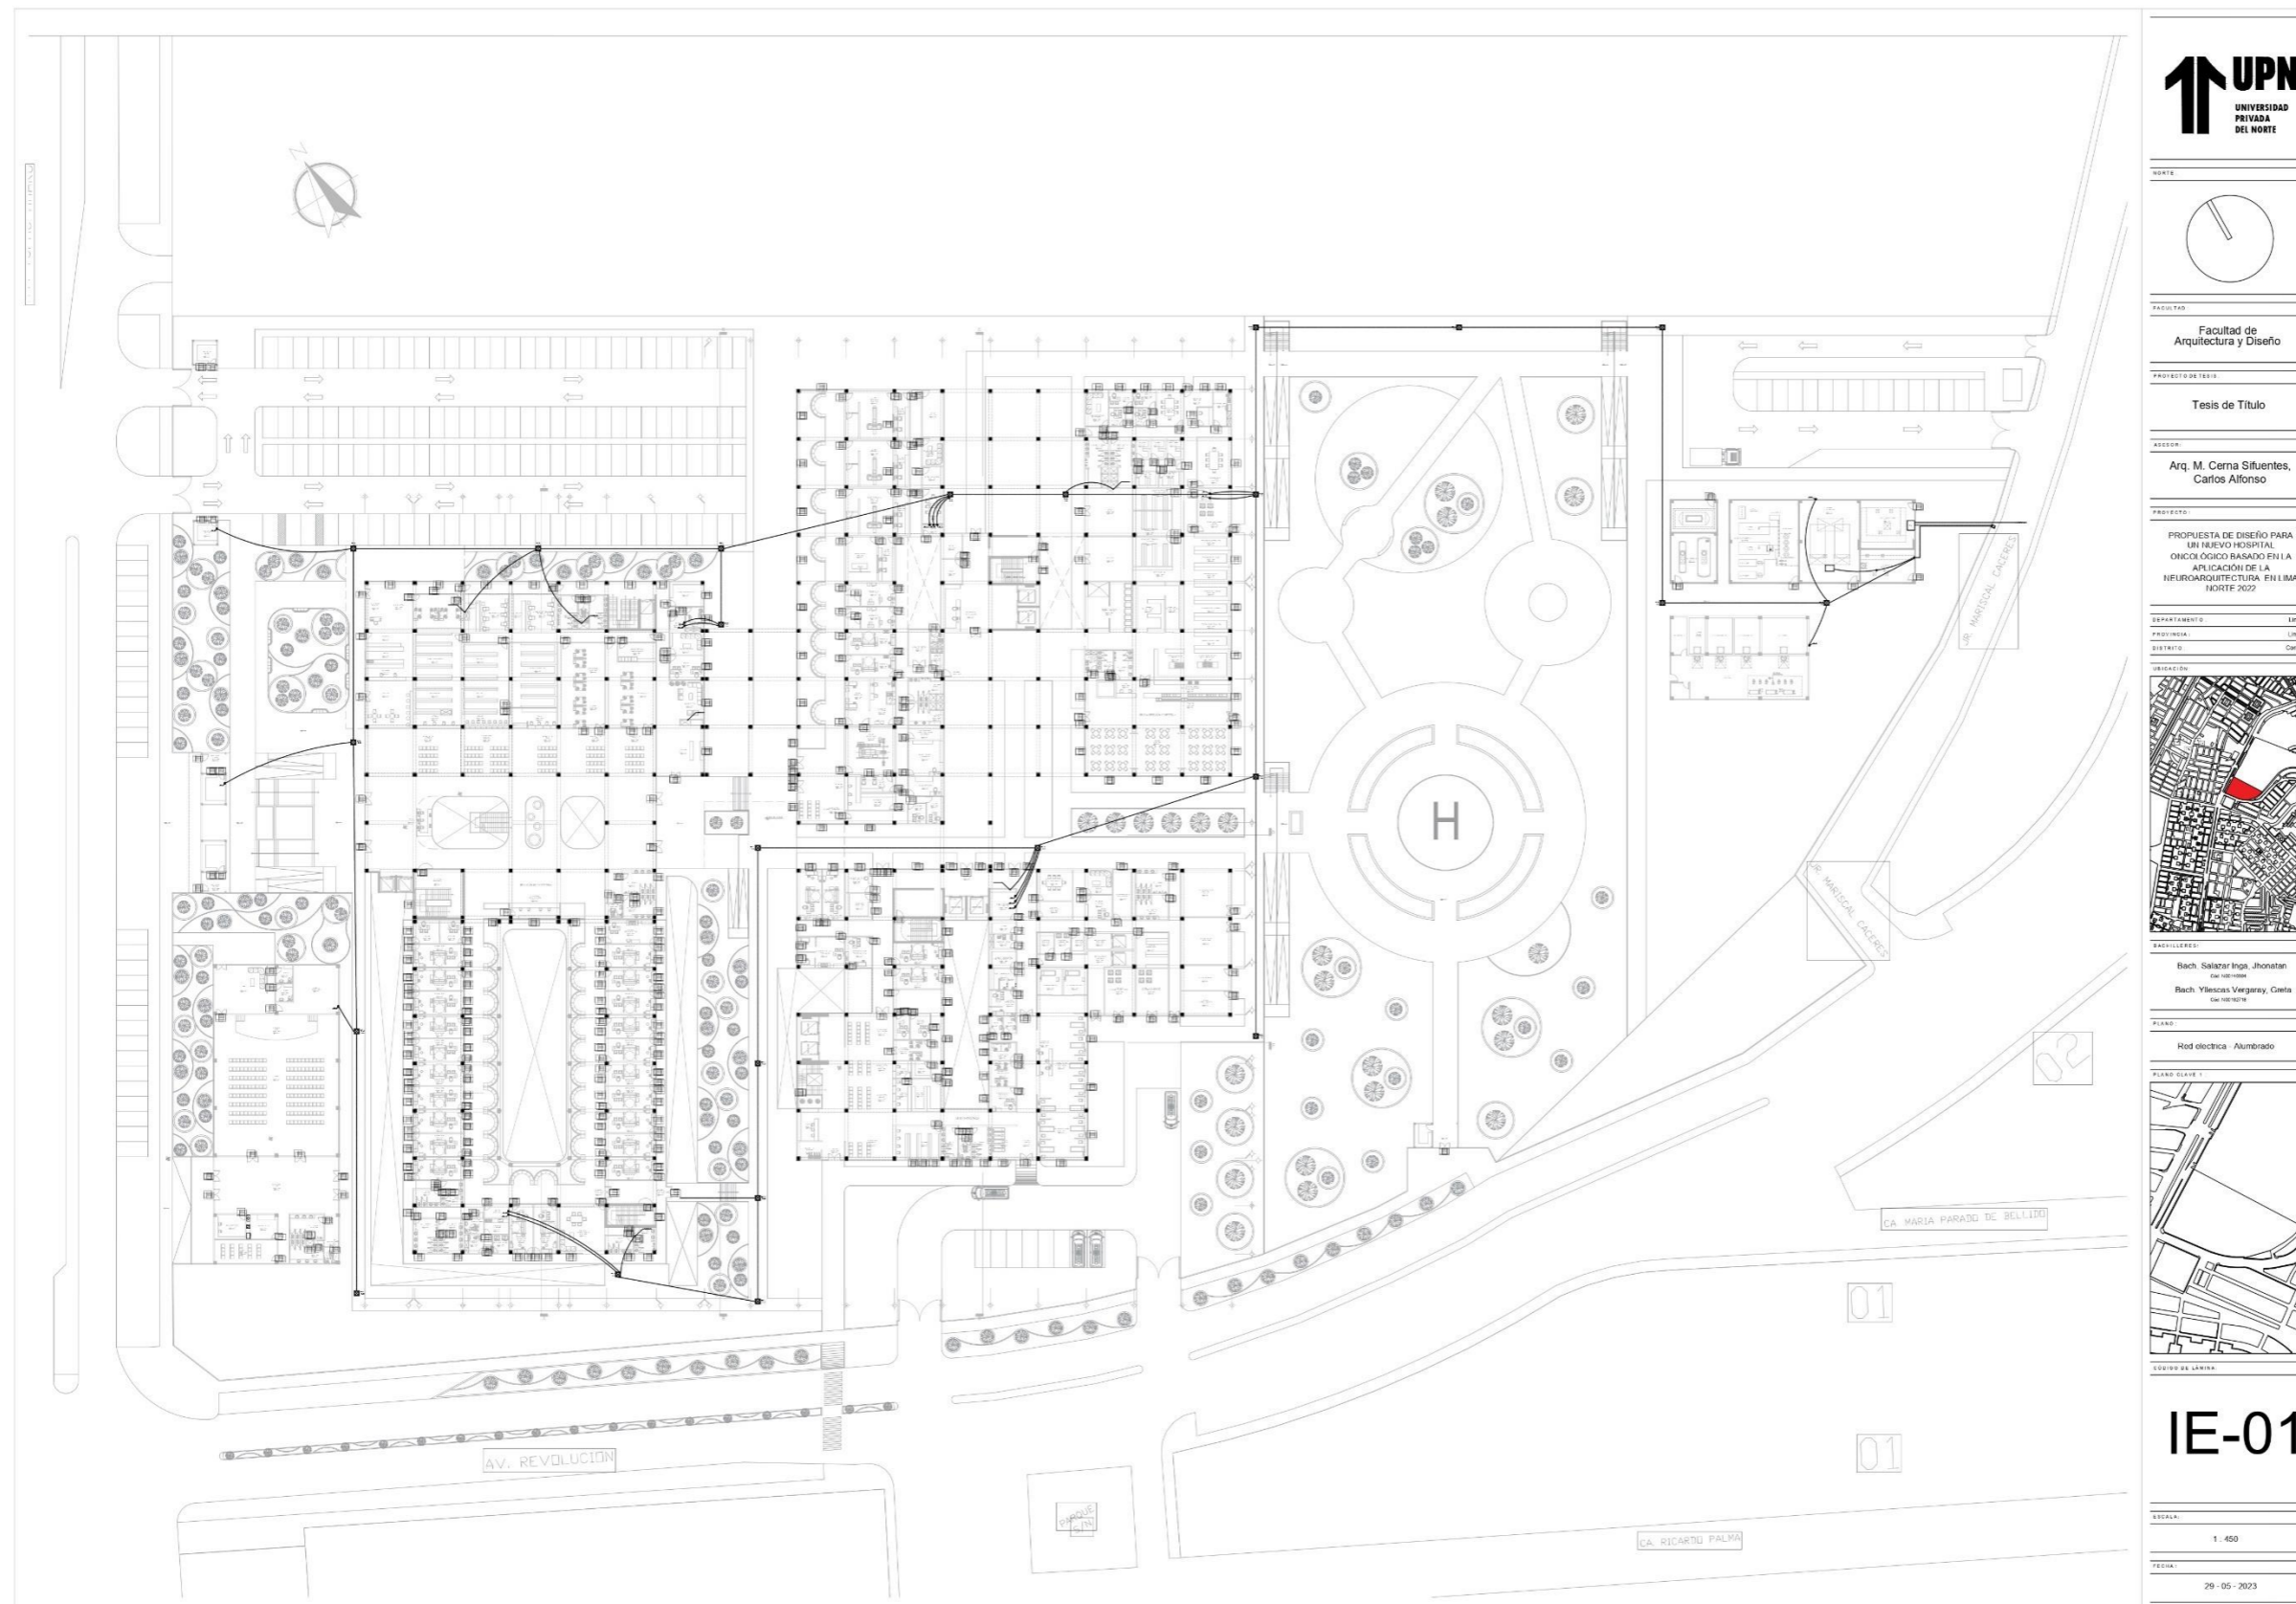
Instalaciones Eléctricas – Plan general Esc: 1/450 (Fuente: Elaboración propia de los coautores)
